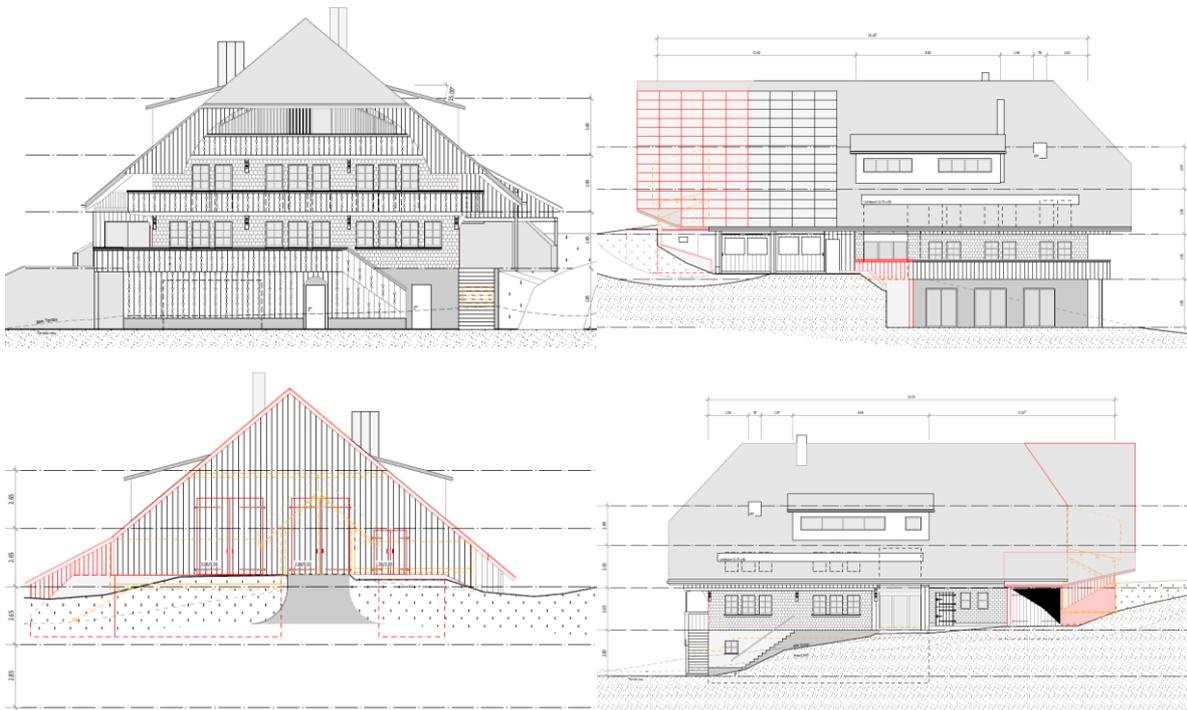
Fassadenansichten Ersatzneubau Vorder Weg 31
